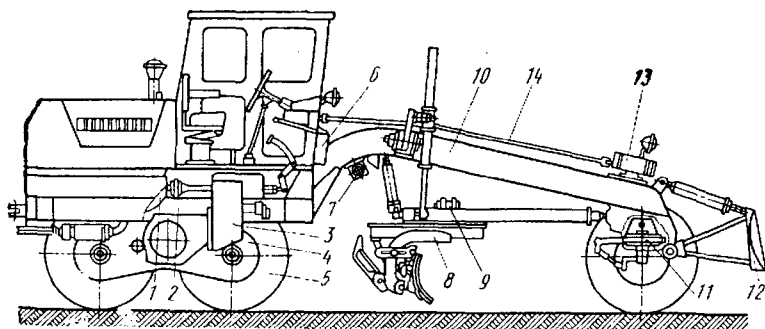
Общий вид автогрейdera: 1 – двигатель; 2 – соединительный вал; 3 – коробка передач с задним мостом; 4 – балансир; 5 – колесо; 6 – распределительное устройство; 7 – гидрораспределитель; 8 – рабочие органы; 9 – гидромотор привода поворотного круга; 10 – основная рама; 11 – передний мост; 12 – бульдозерное оборудование; 13 – рулевой механизм; 14 – карданный вал.
